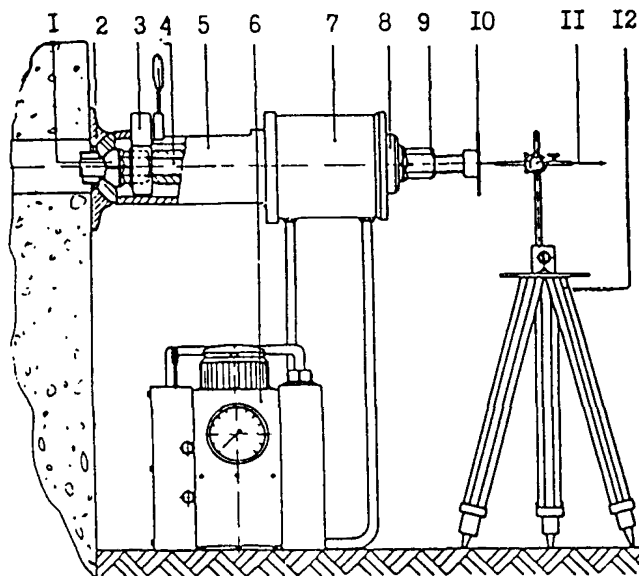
Устройство для натяжения и испытания анкеров: I - сферическая гайка; 2 - опорная плита; 3 - редукционный ключ с трещеткой; 4 - инвентарный удлинитель тяги анкера; 5 - упорный столик; 6 - гидронасосная станция; 7 - гидродомкрат; 8 - шайба; 9 - гайка; 10 - упорная плита; II - индикатор часового типа; 12 - штатив
